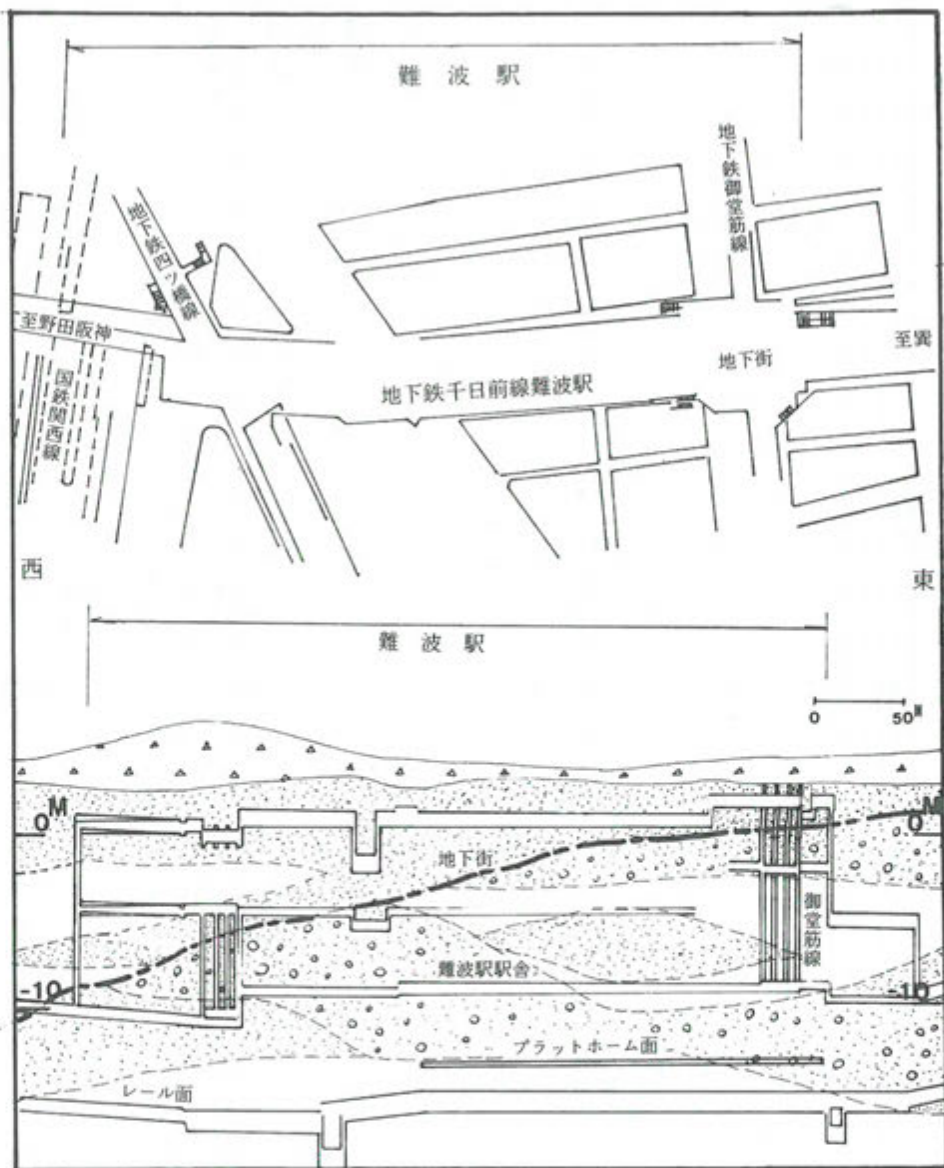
地下鉄(千日前線)難波駅付近の平面図と断面図(凡例は図2参照)
